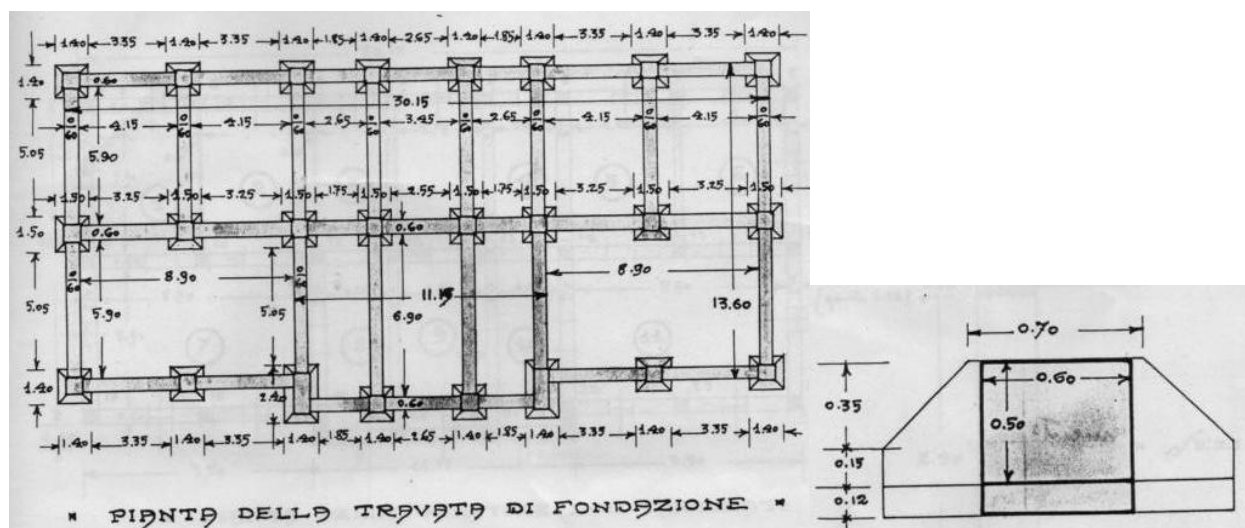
Stralcio del progetto dell'Edificio Comunale - Pianta fondazioni e sezione plinto e trave di fondazione.
